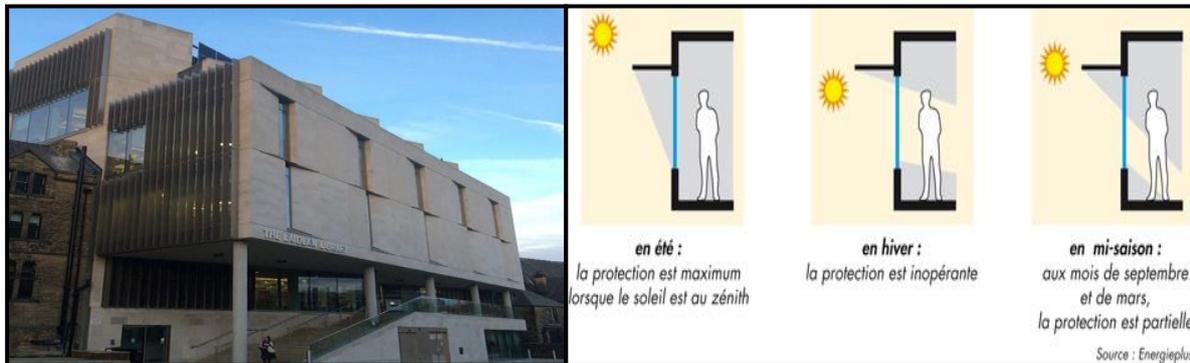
protection solaire dans le bâtiment Source : .eti-construction.fr
